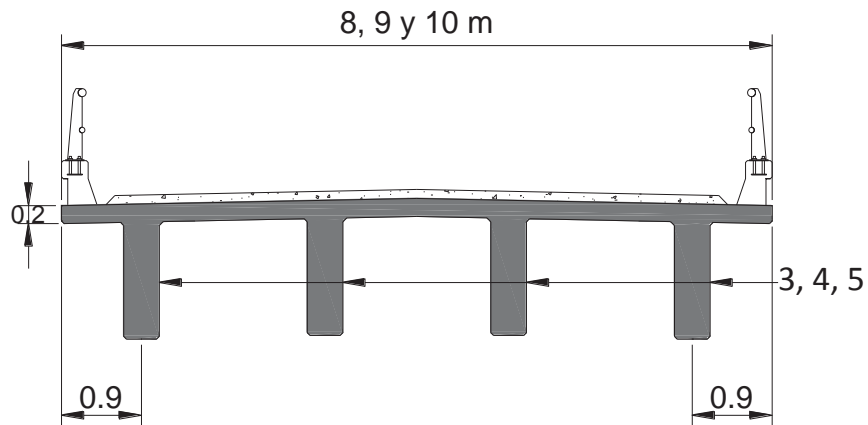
Sección transversal tipo. Losa apoyada sobre traveses de concreto reforzado
